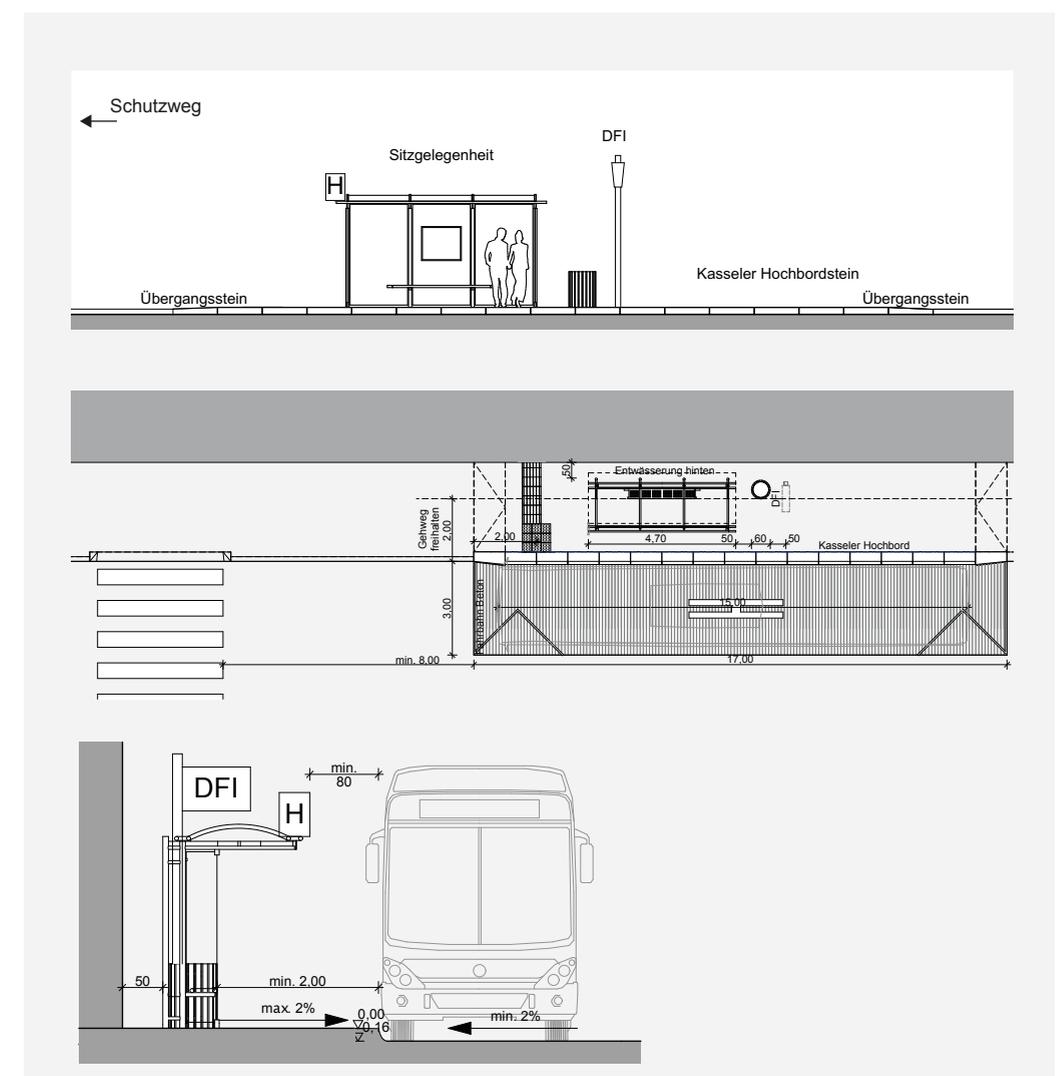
Schema Mindestabmessungen Randhaltestelle mit Wartehaus (Plan: AAPS – Atelier für Architektur ZT GmbH)
